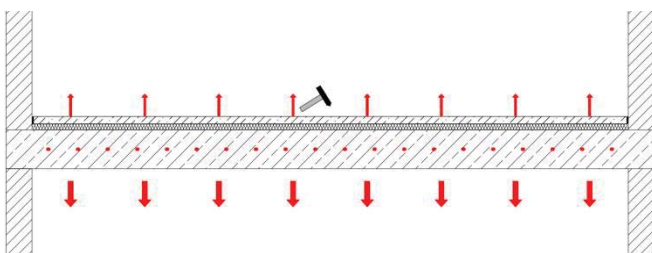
Thermisch aktivierte Decke mit schwimmendem Estrich. Rote Pfeile: Wärmestrom
